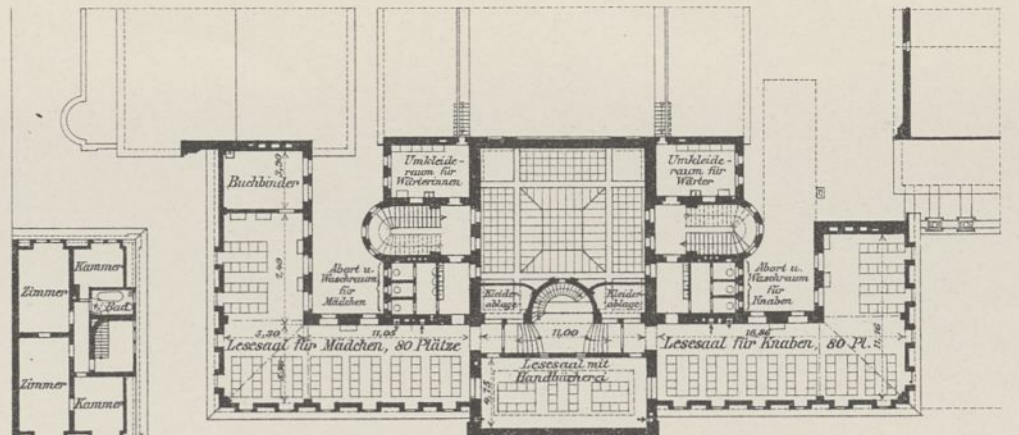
Grundriß des Dachgeschosses. 1: 500.
